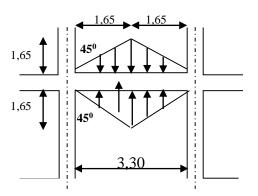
Répartition des charges sur les poutres selon Les lignes de rupture.
